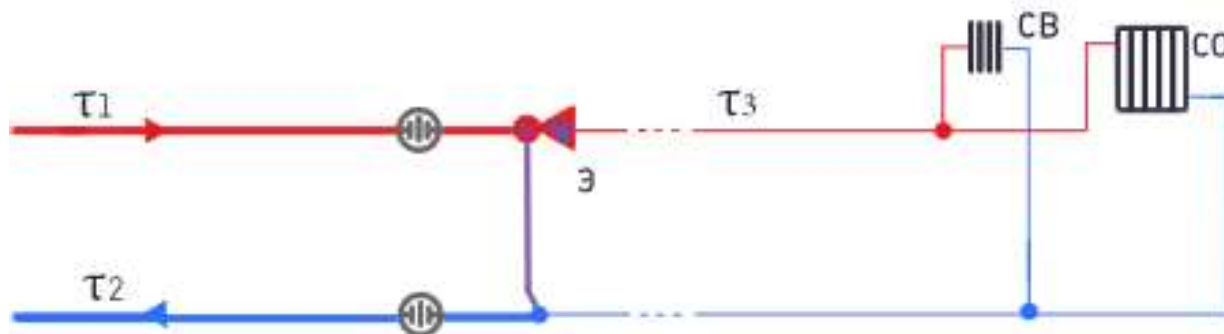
ЦТП с элеваторным присоединением СО и СВ
